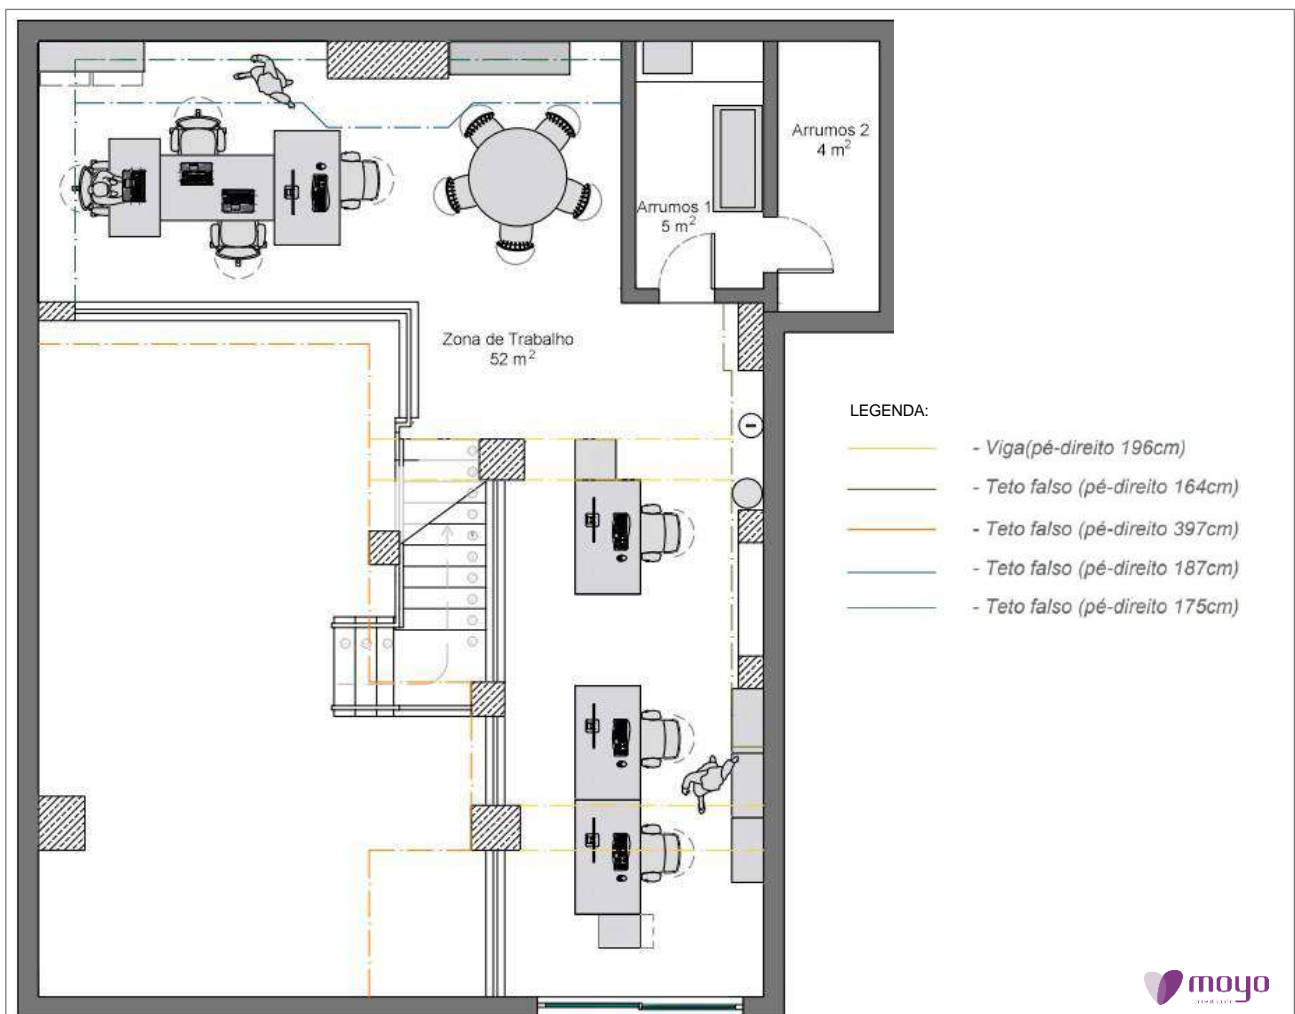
Layout Final Loja Moyo (Piso 1) – Disposição 1
